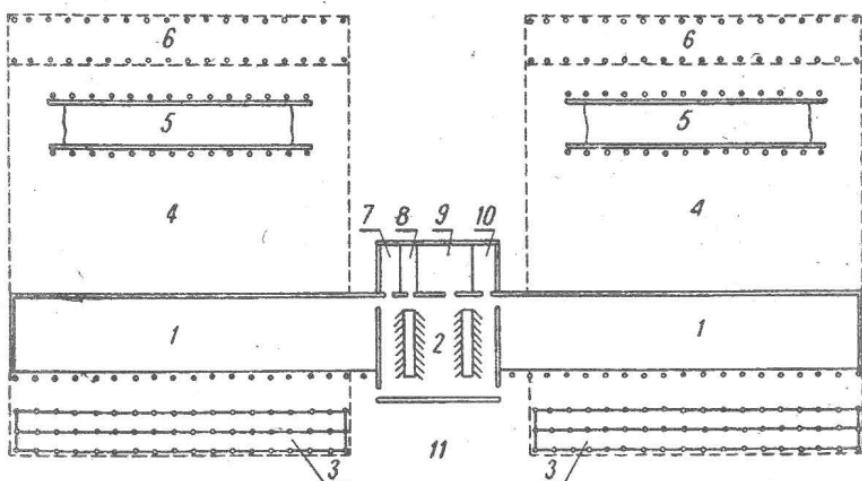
Схема планировки фермы в совхозе «Томский»:
